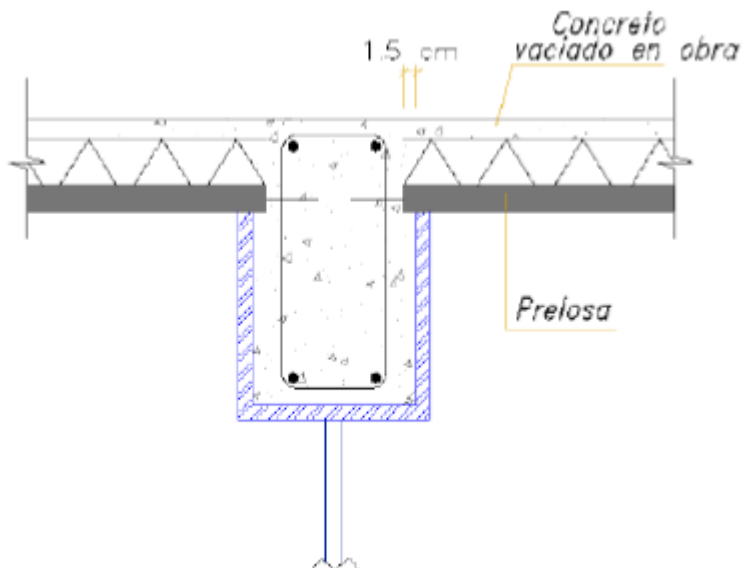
Montaje de 1.5 cm de prelosa sobre la cara de la viga.
